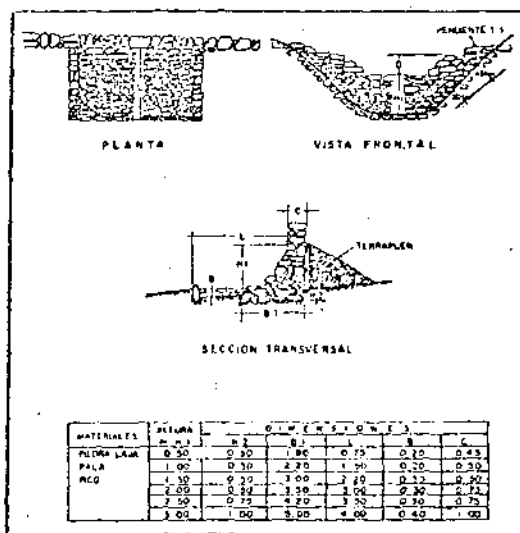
Características de las presas de control de azolves por construir con piedra laja.
